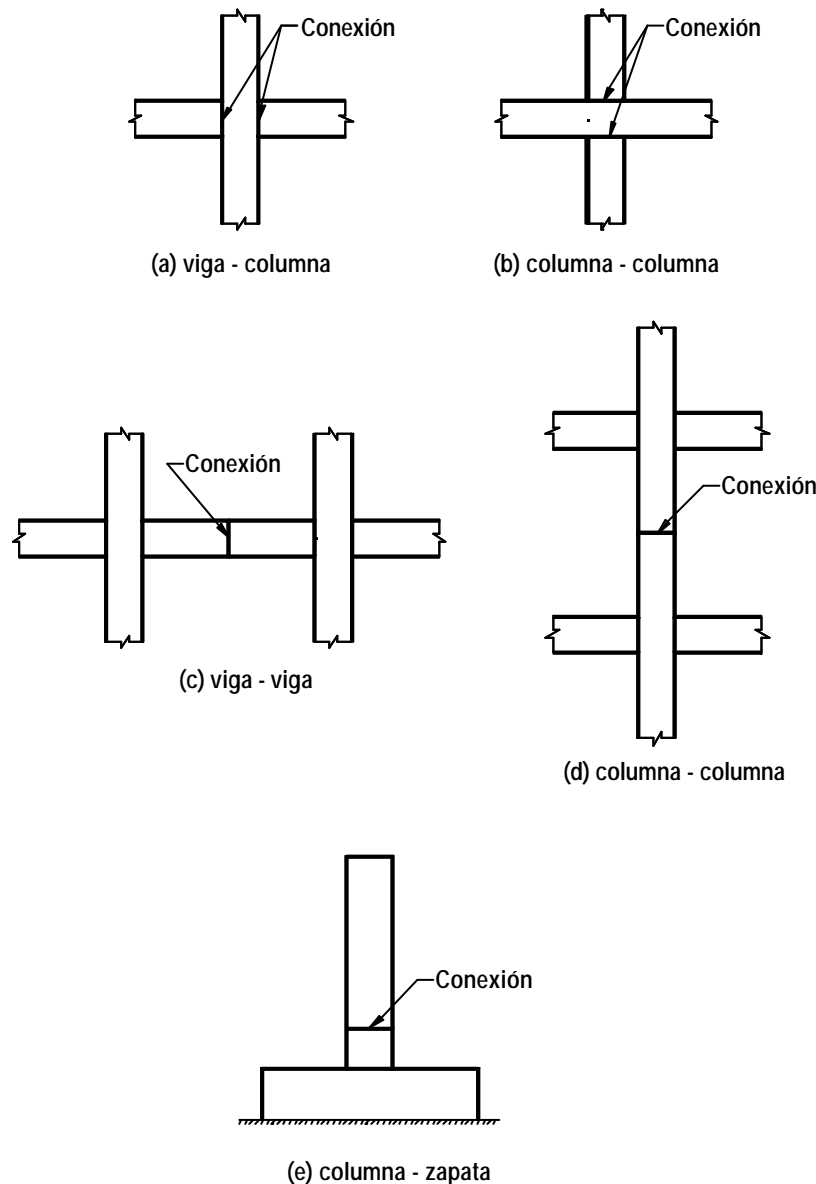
Diferentes geometrías de conexiones en elementos prefabricados (Ghosh et al., 1997)
